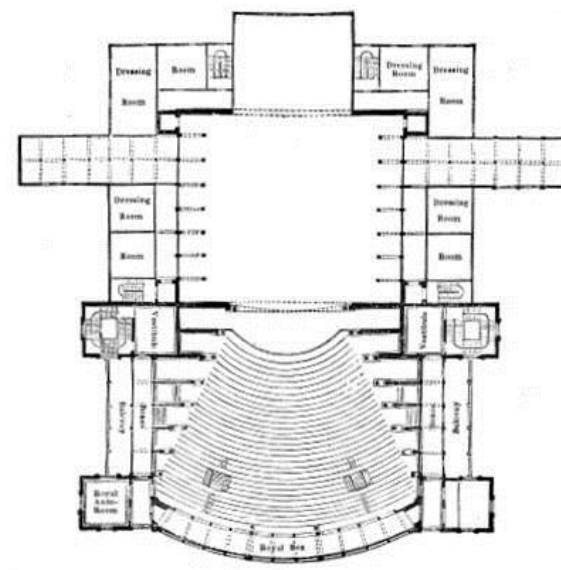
Planta do *Bayreuth Festspielhaus*²⁰
